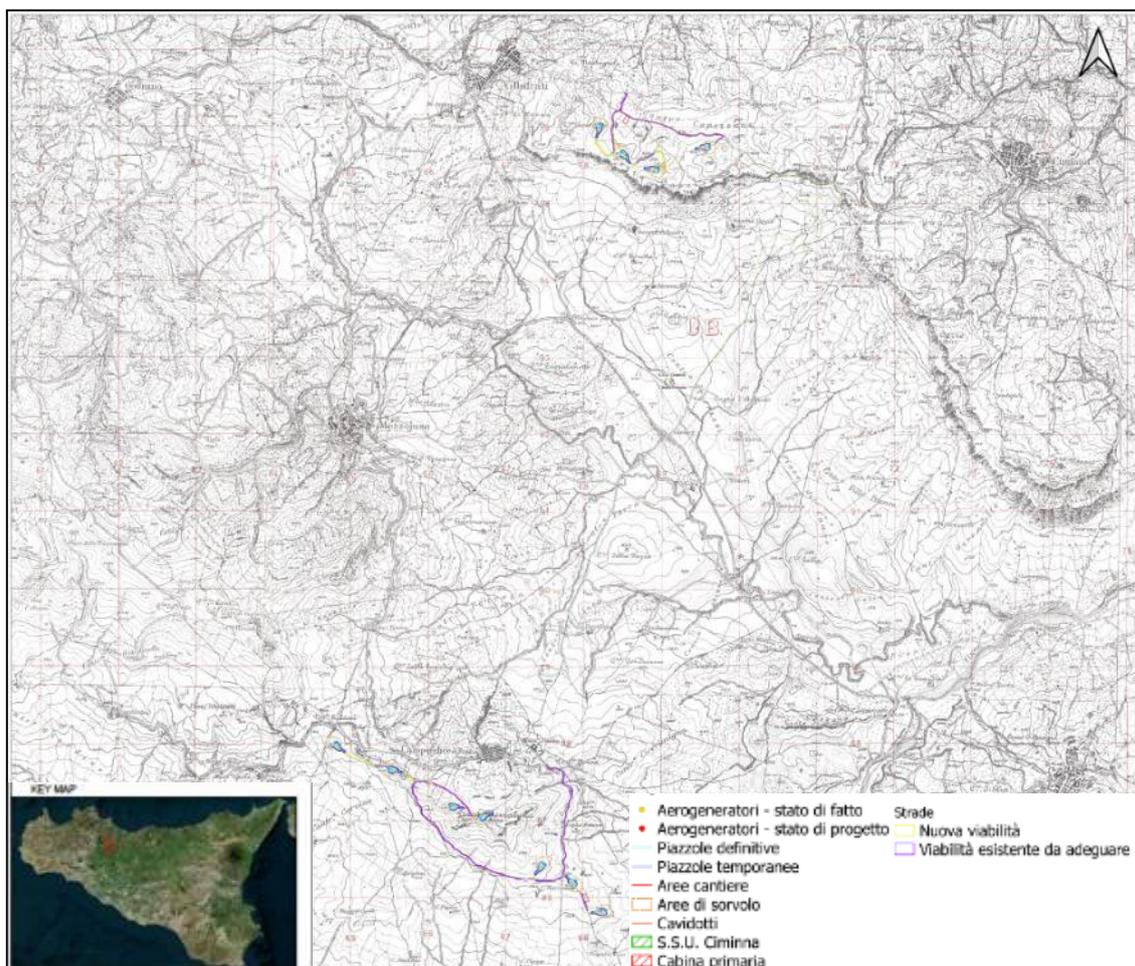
Inquadramento su stralcio I.G.M. dell'area dell'impianto VRG-040 nel suo stato di fatto e di progetto
